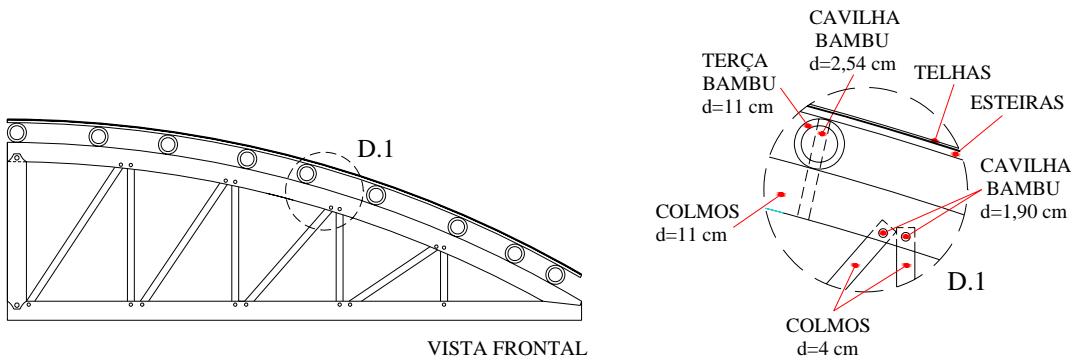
Concepção da coberta - Modelo CB01 (vista frontal e detalhe).
